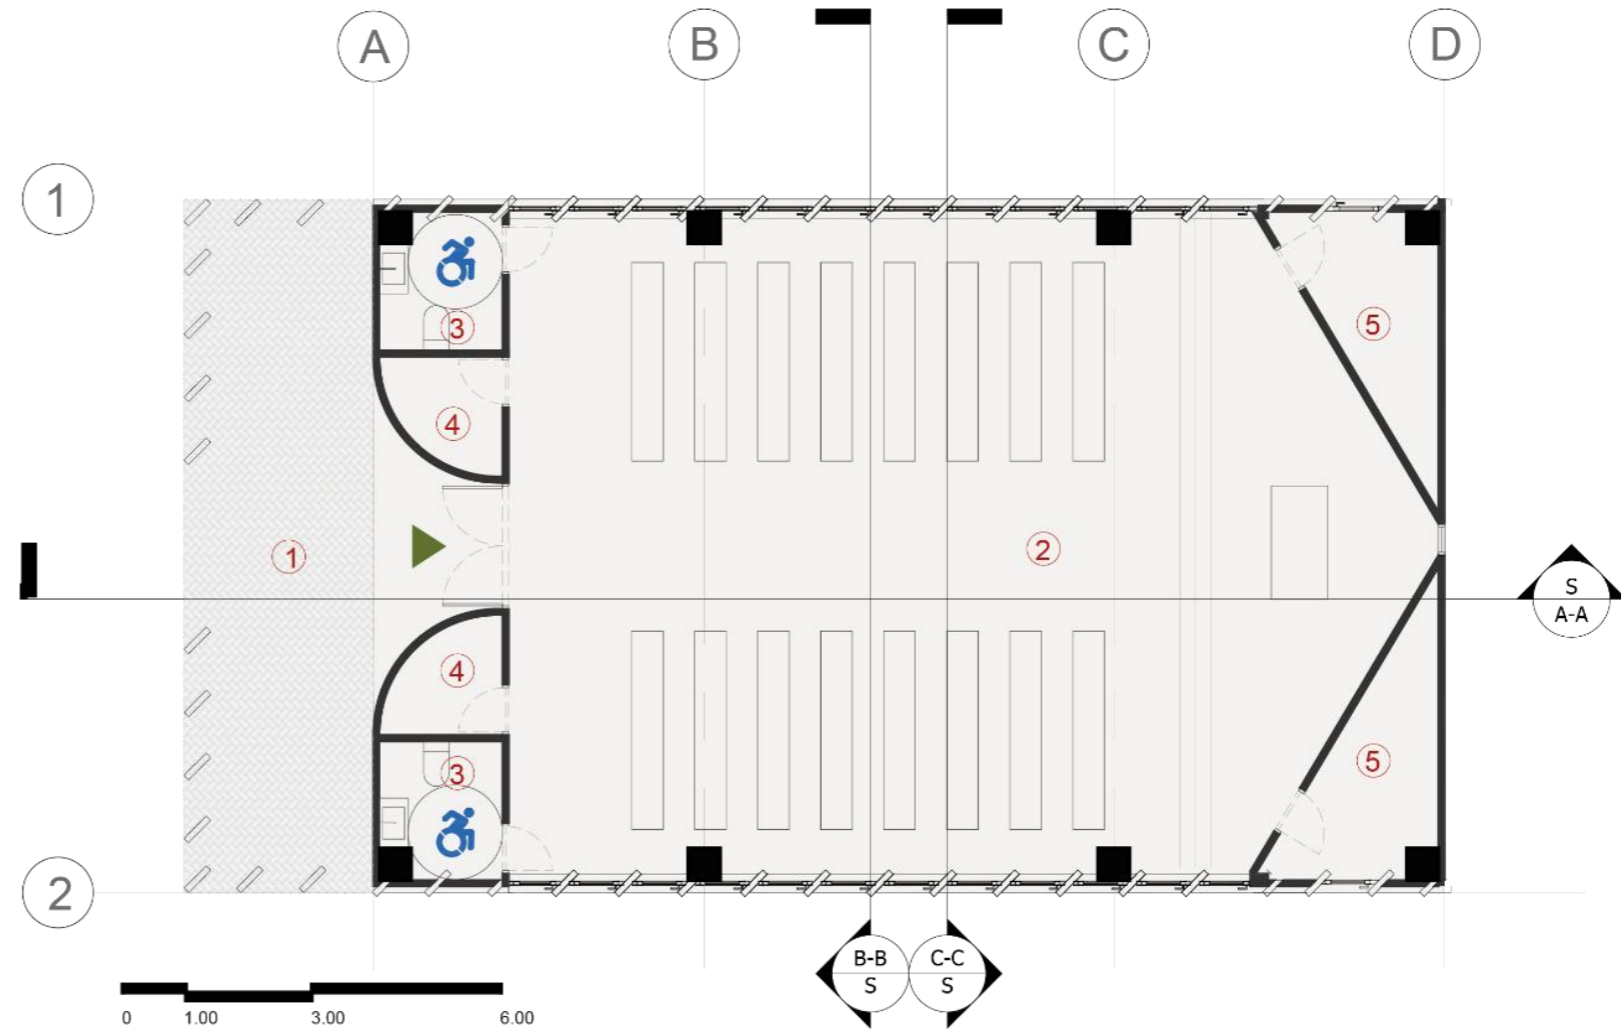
Planta arquitectónica de edificio 4 Capilla y Velación 02
